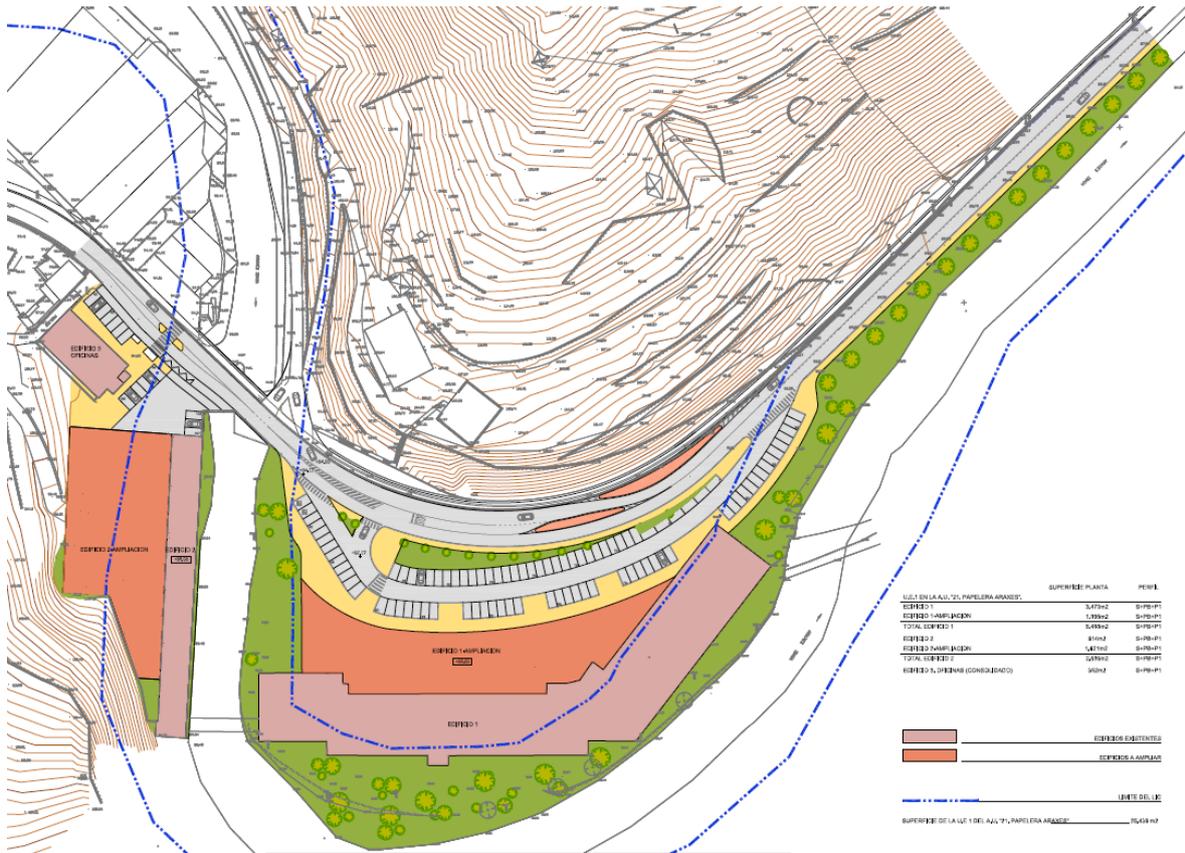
Propuesta de ordenación pormenorizada del Plan Especial de Ordenación Urbana. Fuente: Plan Especial
